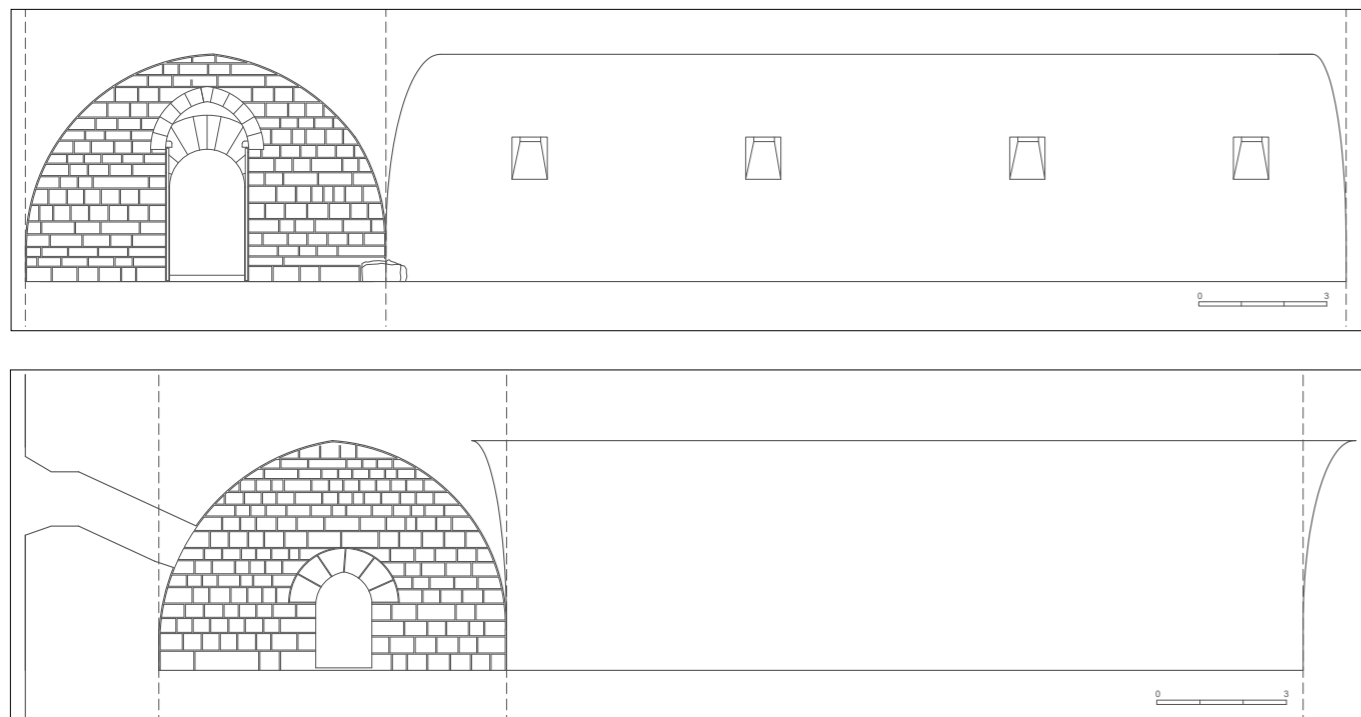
Desarrollo de alzados de la sala principal de las caballerizas. Estado anterior a la restauración. Proyecto de restauración ambiental. (MJB 2013).
